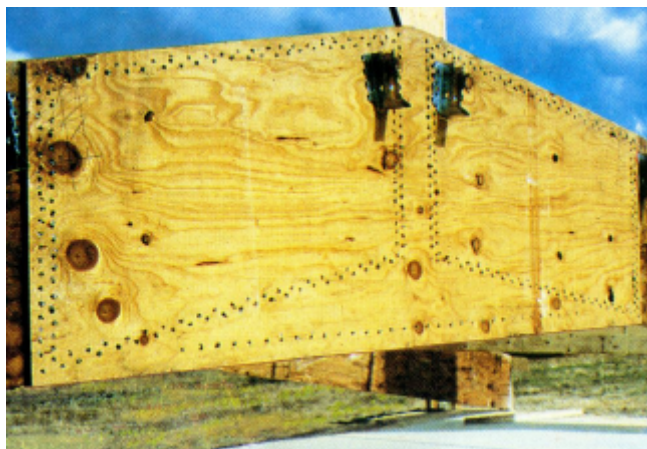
Detalhe da cumeeira da estrutura em pórtico utilizando madeira compensada - fonte: IPL
